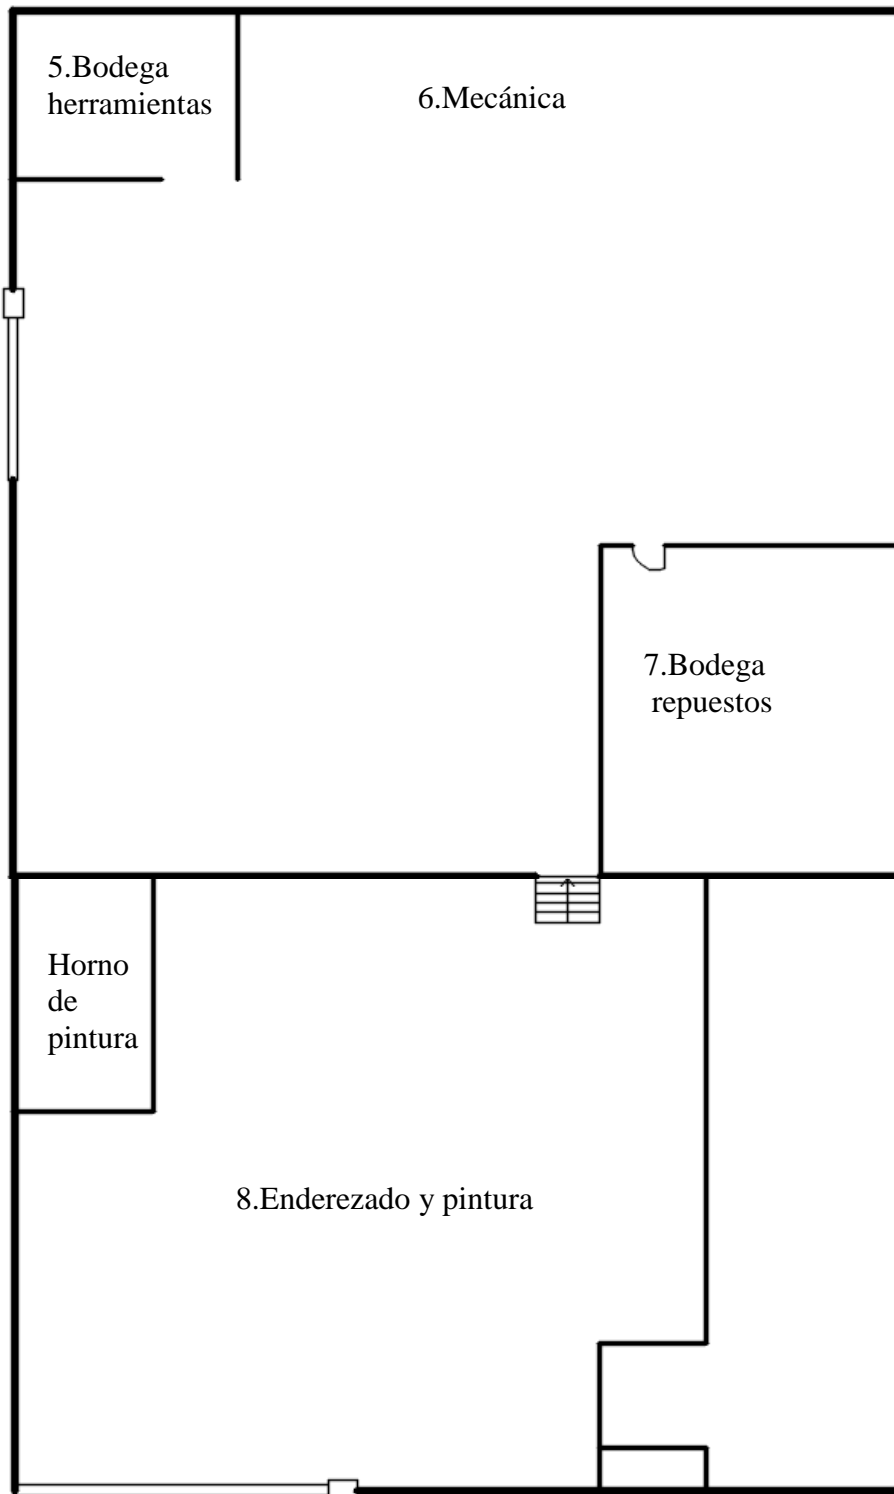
Croquis Kilómetro Mil planta de reparación
